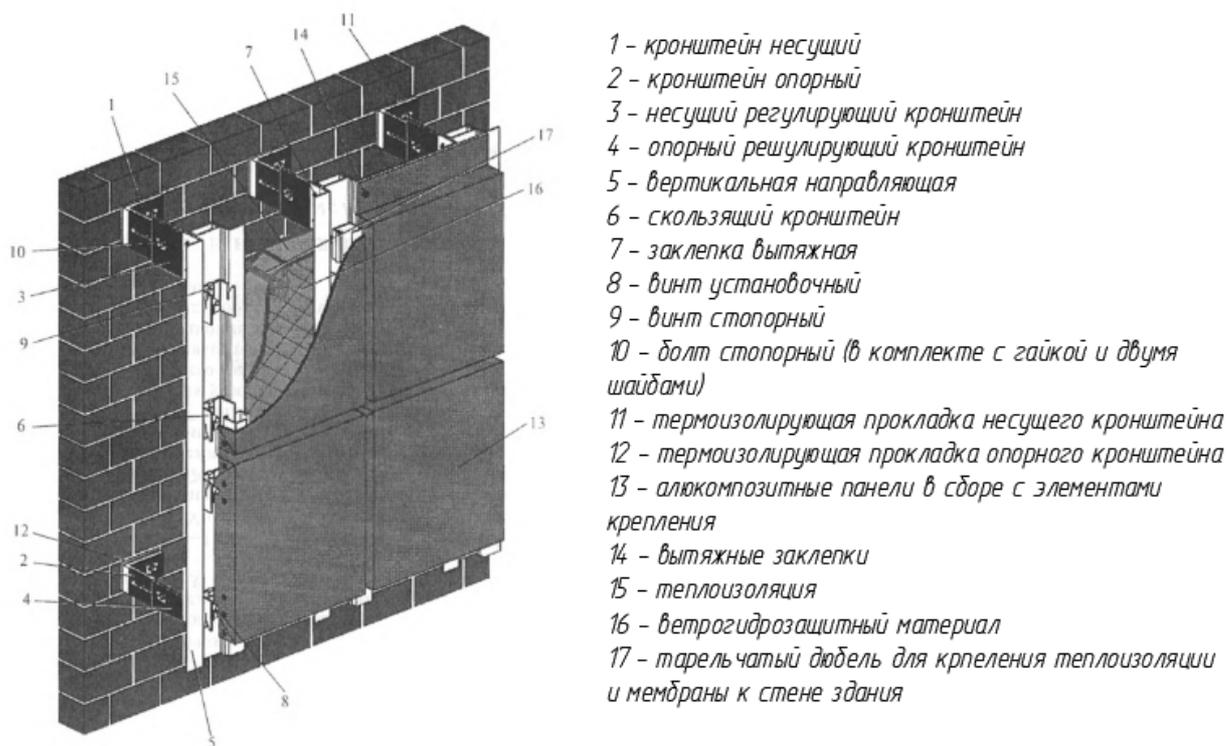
Фрагмент вентилируемого фасада системы FS-300
